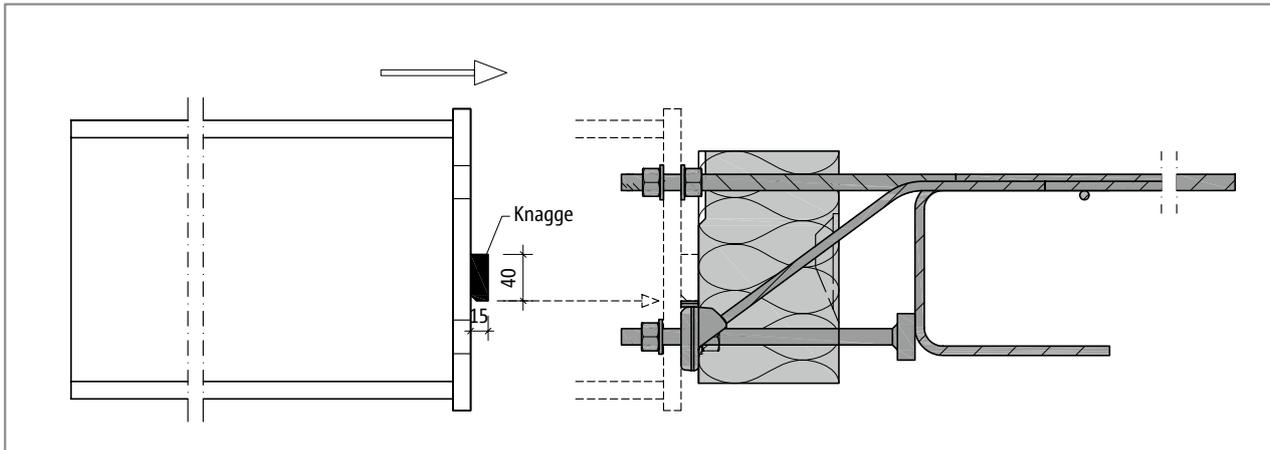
Schöck Isokorb® XT Typ SK: Montage des Stahlträgers
